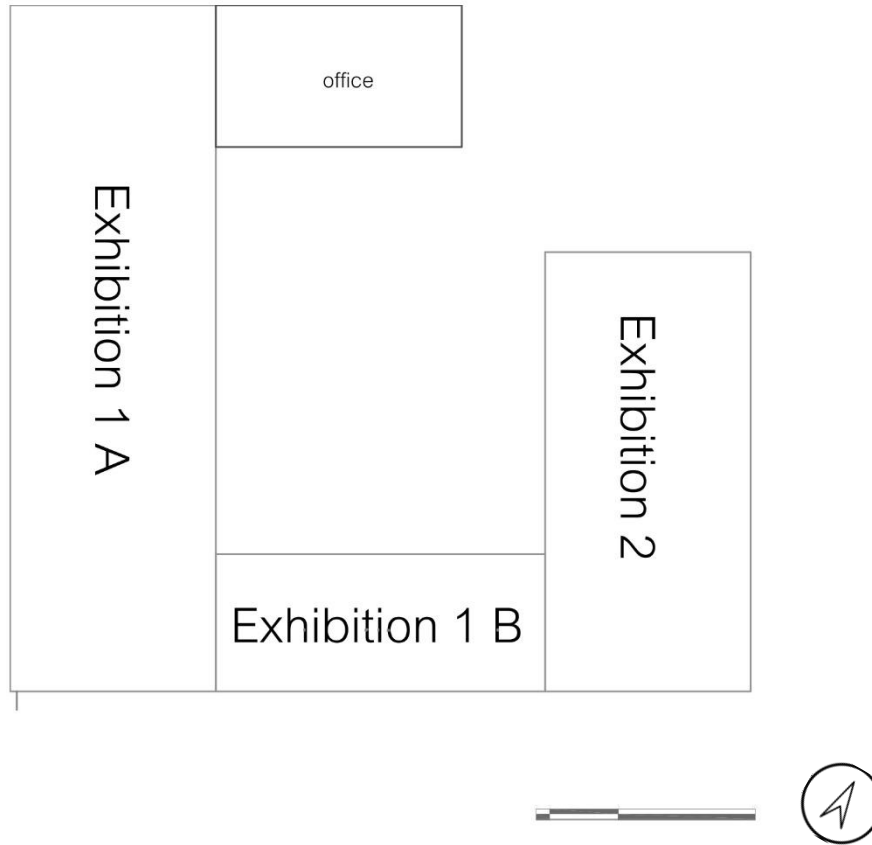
Schematic design 2 - 2nd floor plan - ธันวาคม 2021
